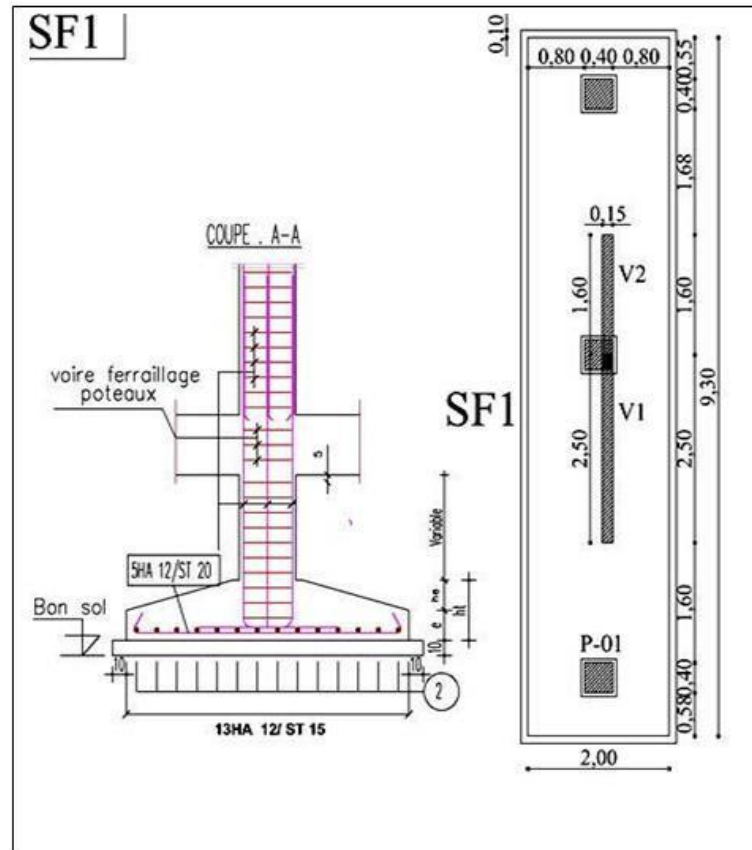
Schéma exemplaire de ferrailage de la semelle filante SF1
